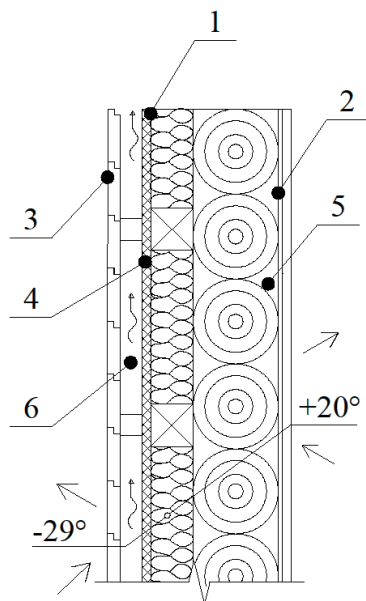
Конструкция стены из оцилиндрованного бревна с наружным утеплением 1 – минераловатная изоляция ISOVER; 2 – пароизоляция ISOVER; 3 – обшивка; 4 – ветрозащитный материал ISOVER SKL; 5 – теплоизоляция швов ISOVER TK; 6 – воздушный зазор
